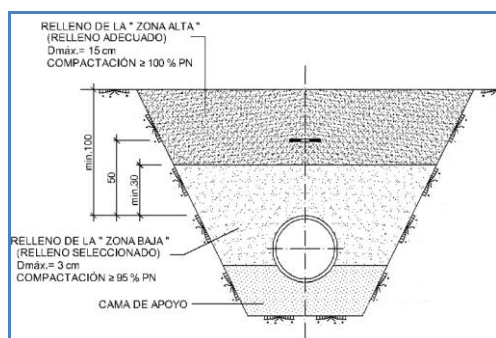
Sección tipo de zanja para tubería de fundición dúctil en terreno natural
